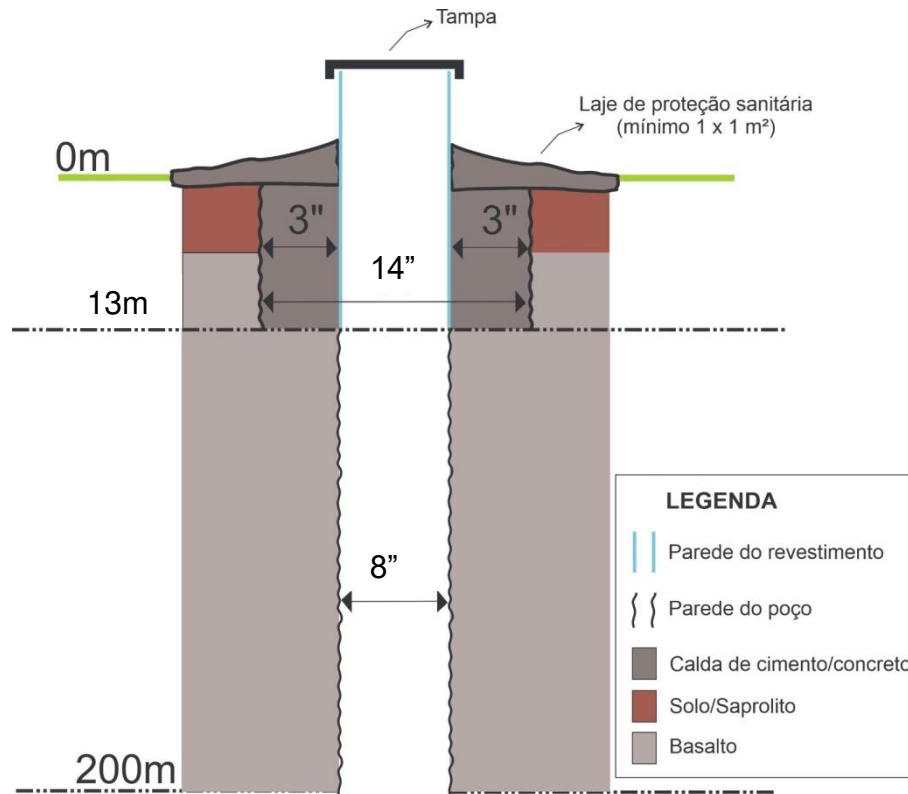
Perfil Geológico e Construtivo de Perfuração;
